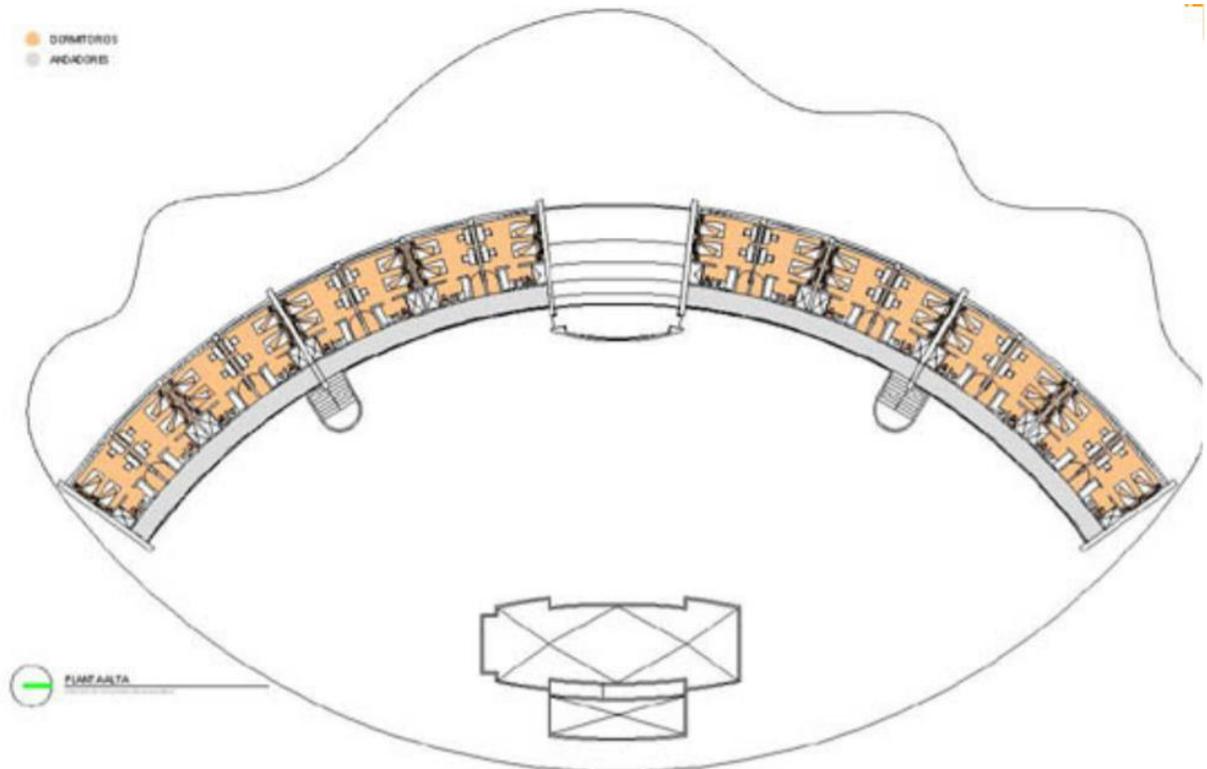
Esquema Arquitectónico planta alta. (Becerra, 2016)
